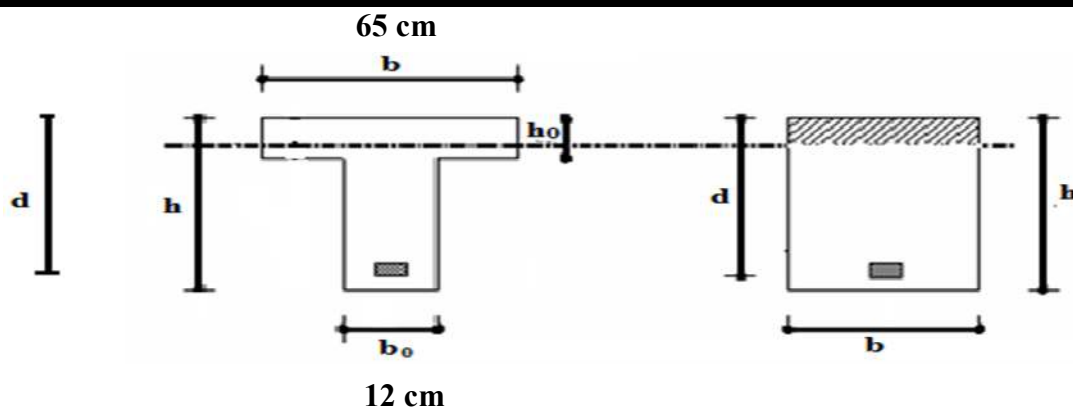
Section rectangulaire et section en “Té” en travée.
